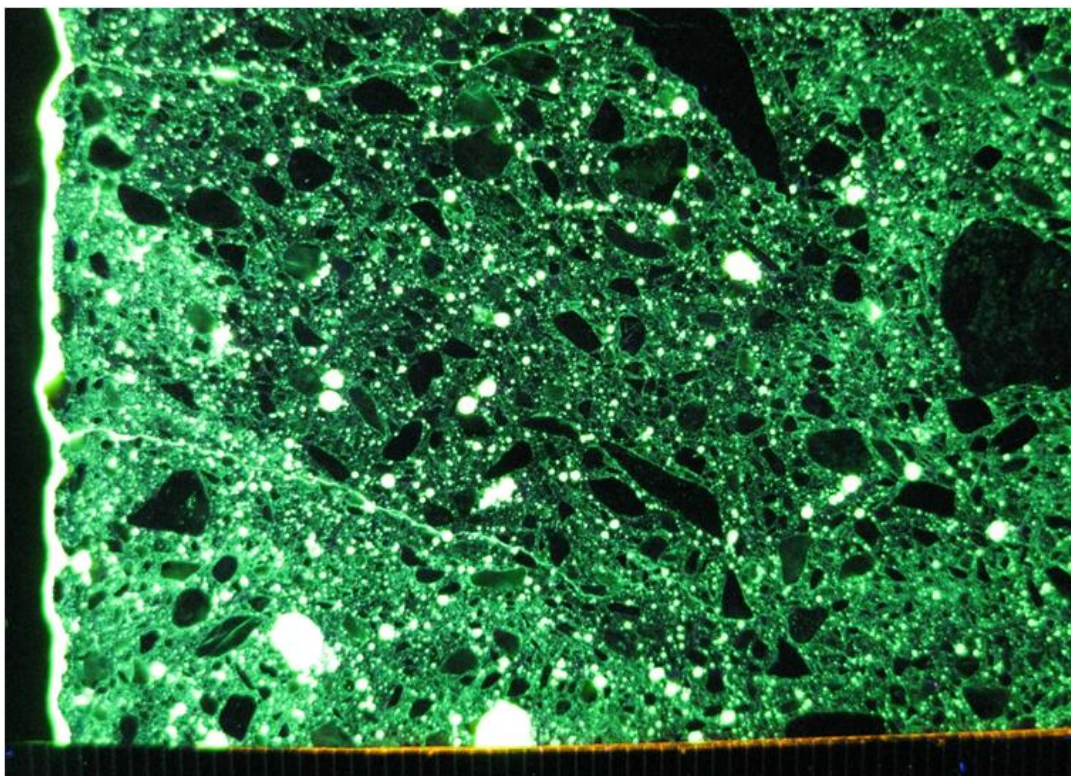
Prov A8, från Ajaure. Planslip belyst med UV ljus. Planslipets längd är 210 mm. Betongens yta finns till vänster i bilden.
